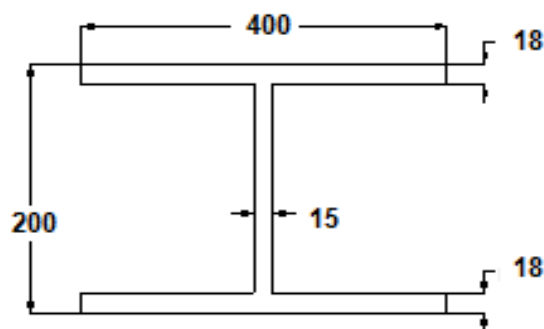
Perfil de acero de vigas y diagonales de Contraviento.
